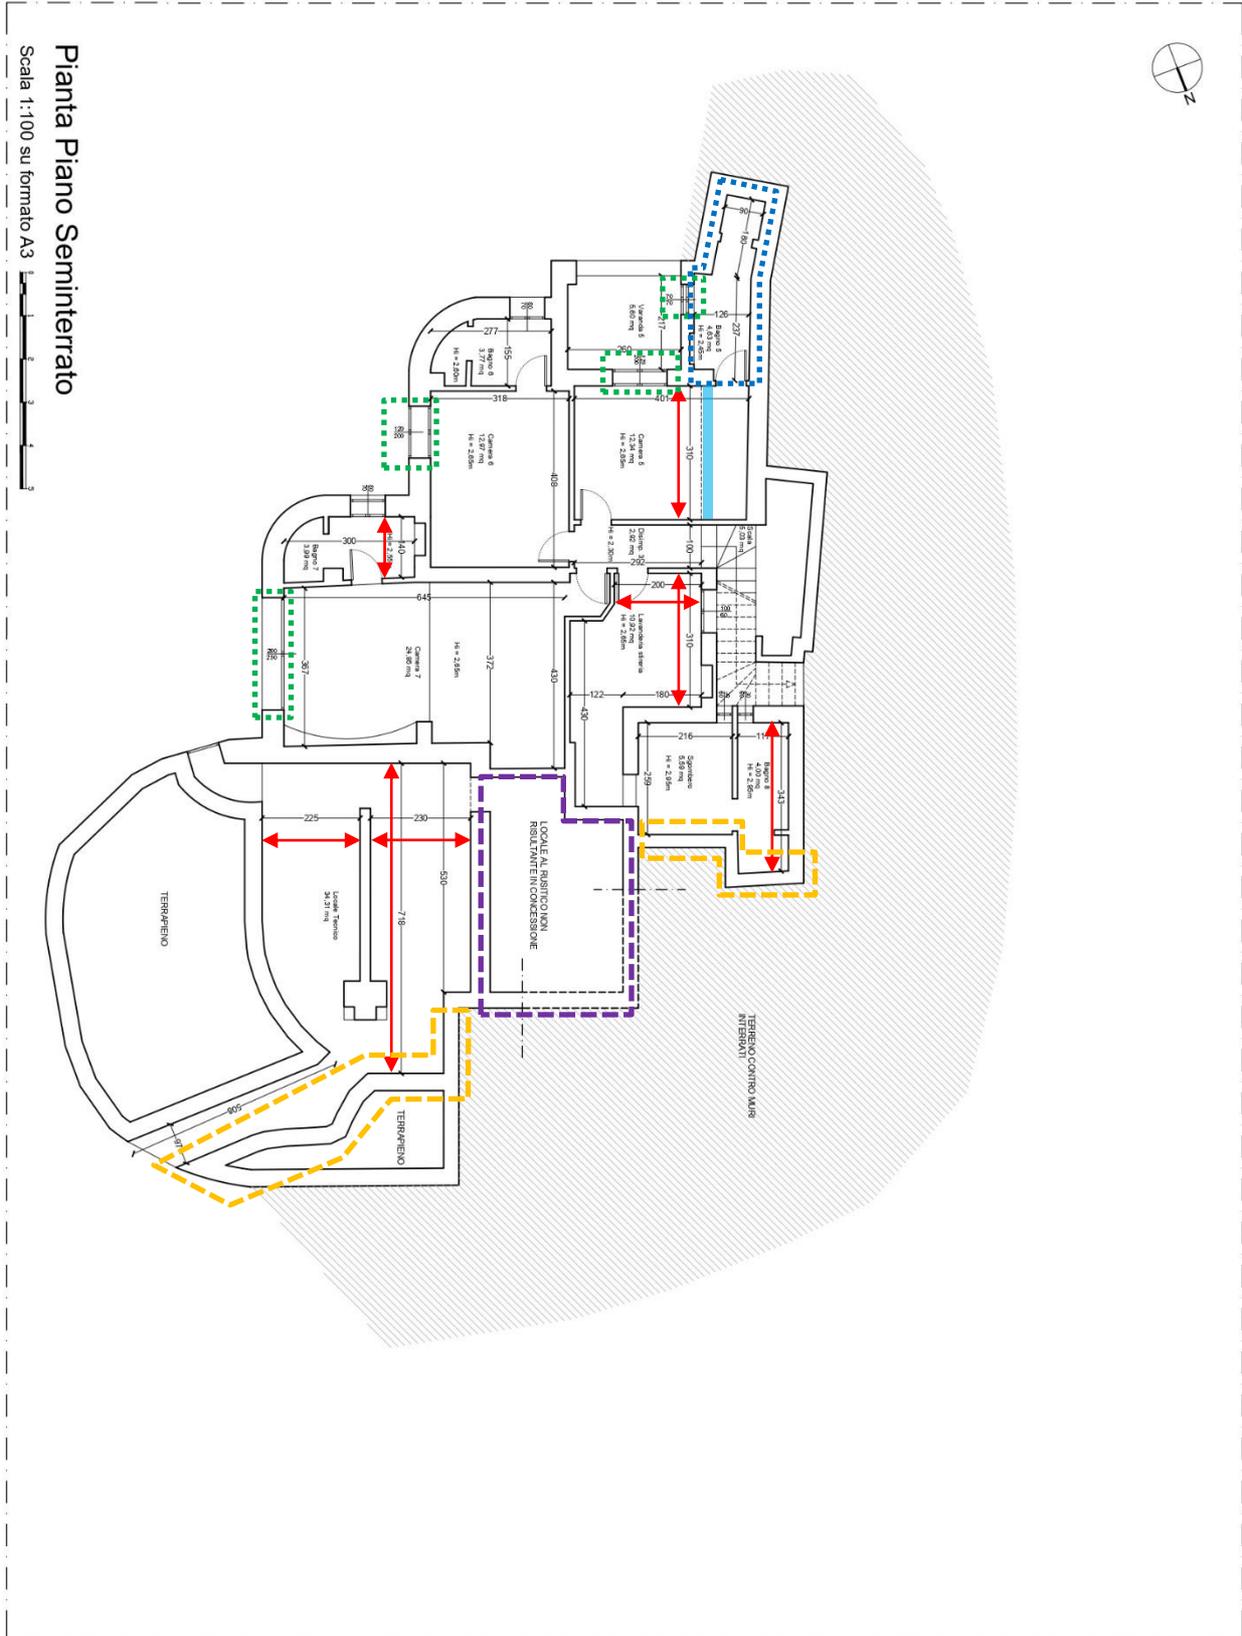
Planimetria stato di fatto con evidenziati gli elementi difformi rispetto a quanto approvato
